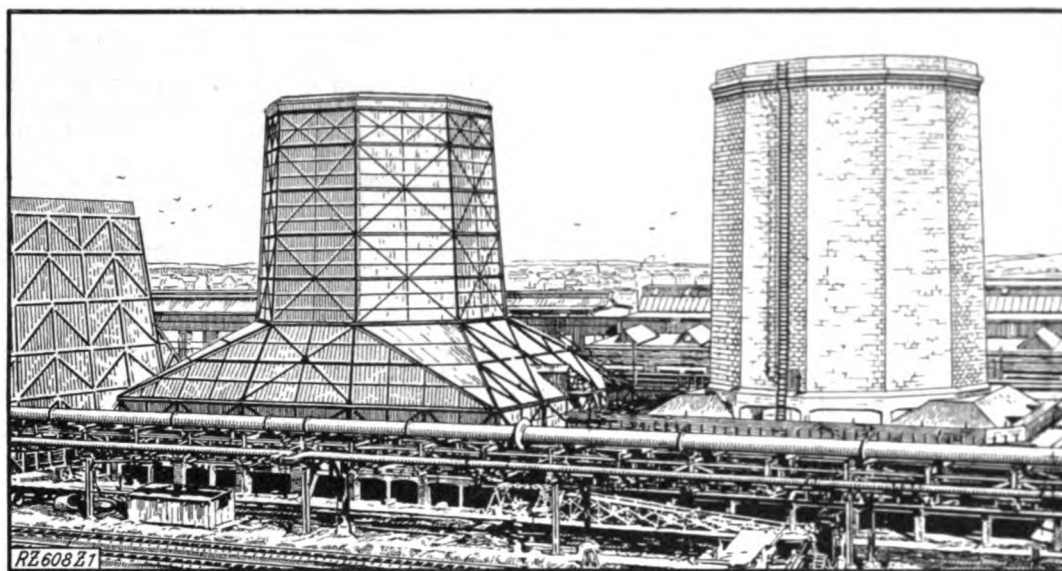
Kühlturm aus Eisenbeton, rechts neben älteren Kühltürmen in Holz- und Eisenkonstruktion.
